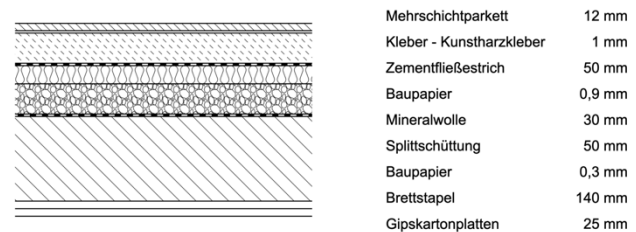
Detail Deckenaufbau Brettstapeldecke (maßstabslos)
